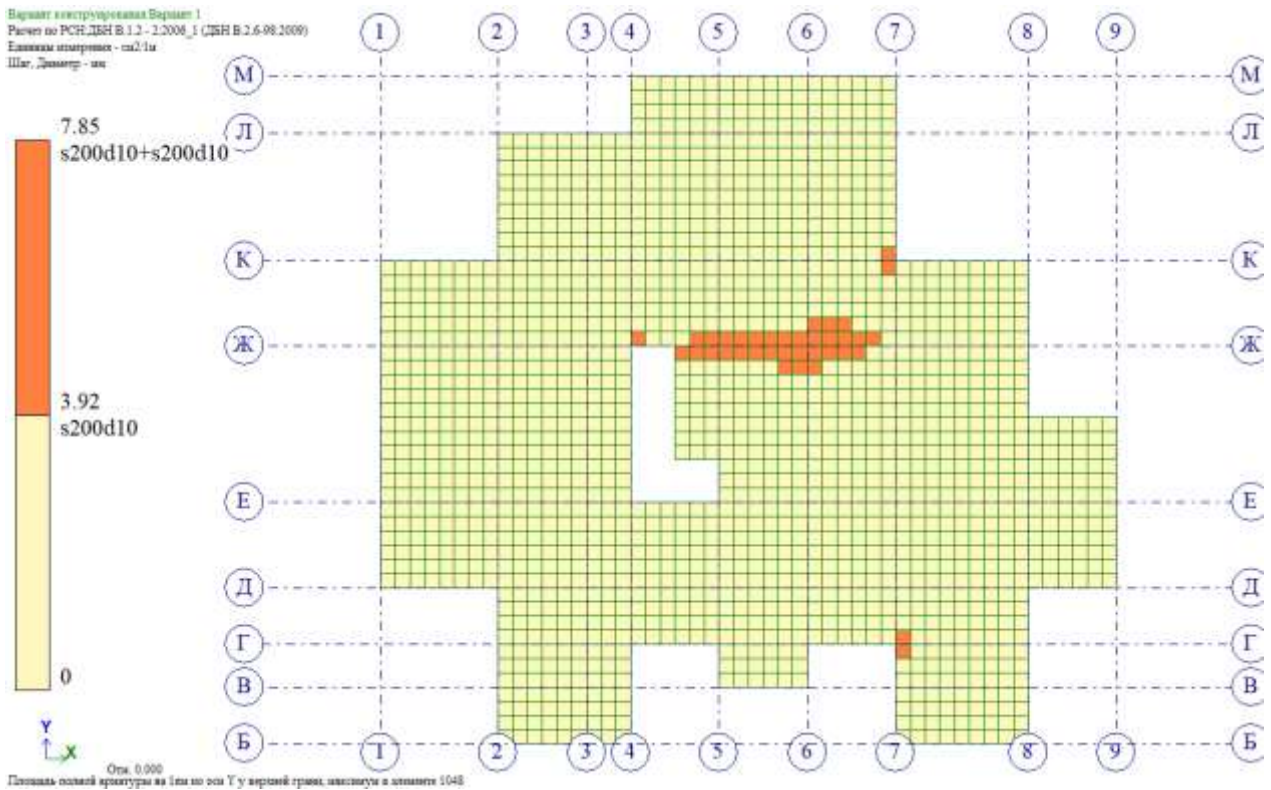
Арматування плити перекриття по верхній грані вздовж осі Y
